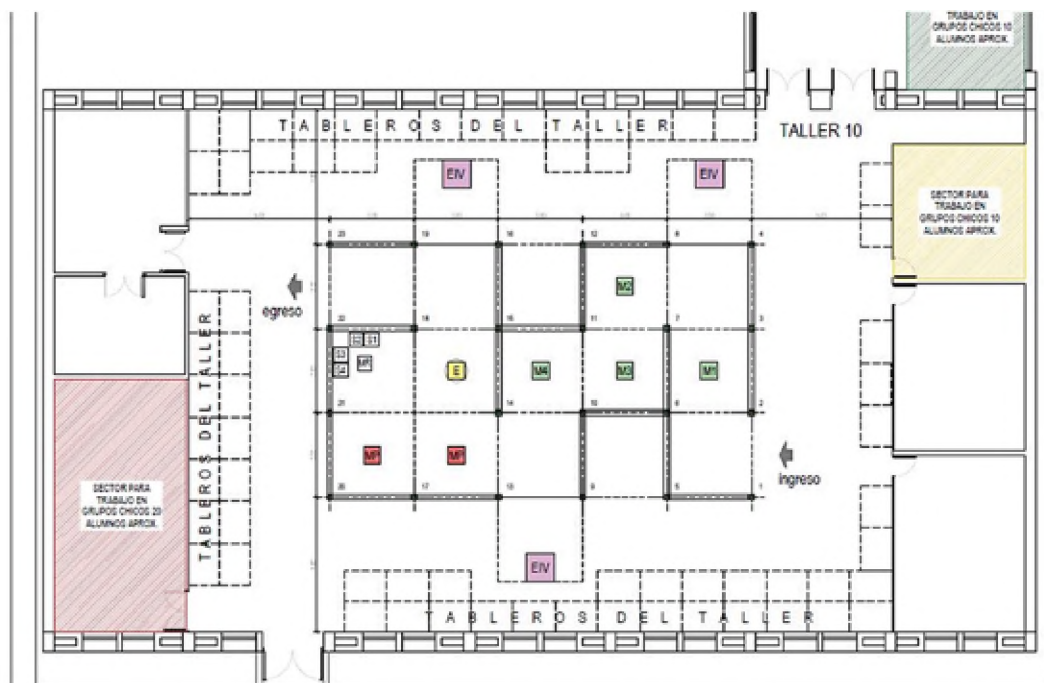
Planta de propuesta espacial de recorrido. Sectorización de áreas de trabajo. Fuente: elaboración propia
